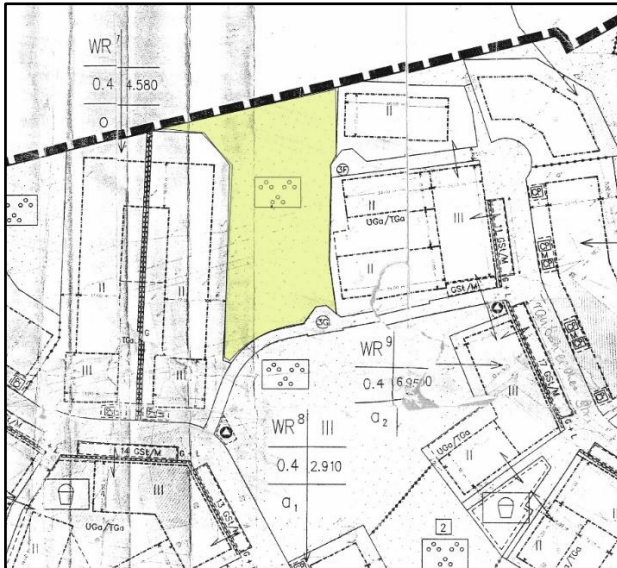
Planausschnitt B-Plan Nr. 4 Schönfließ Süd vom 03.05.1995 (nachträgl. gekennzeichnet)
